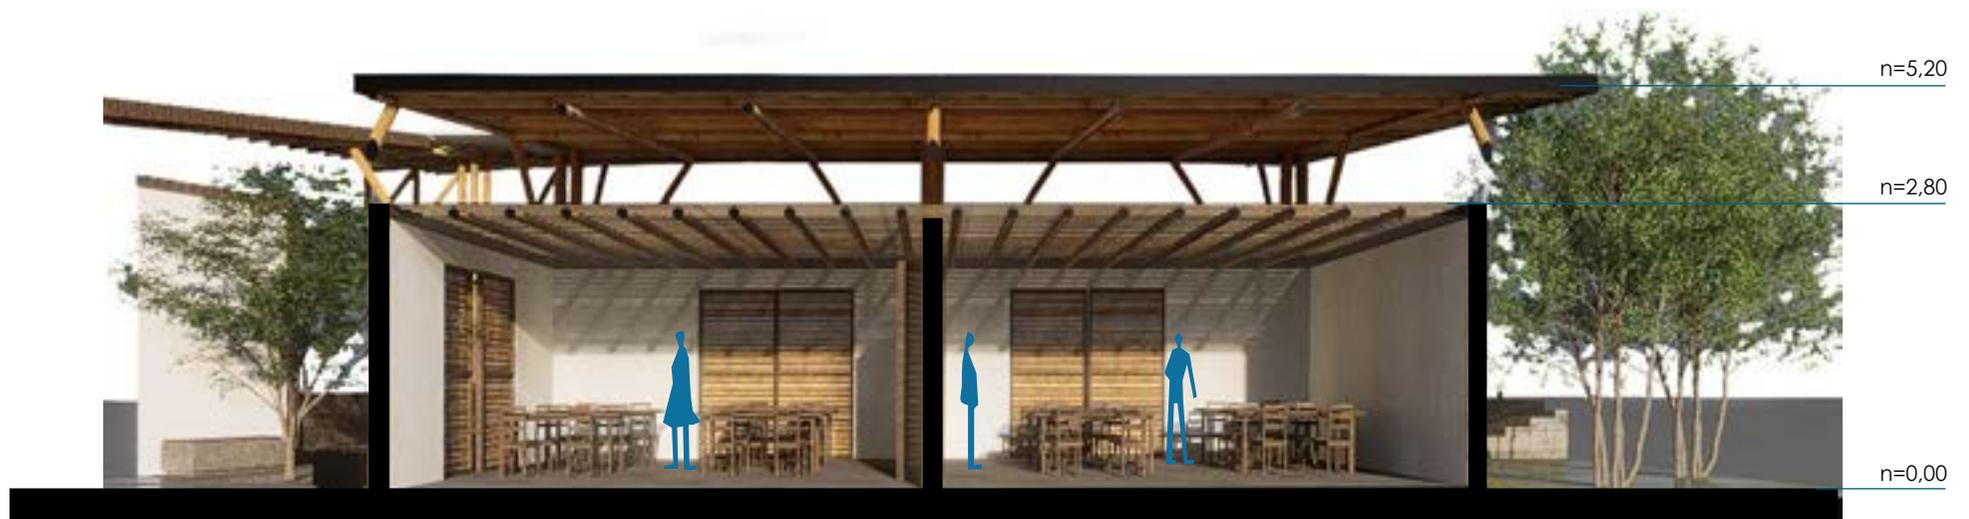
Sección de las aulas. Fuente: Elaboración Propia
